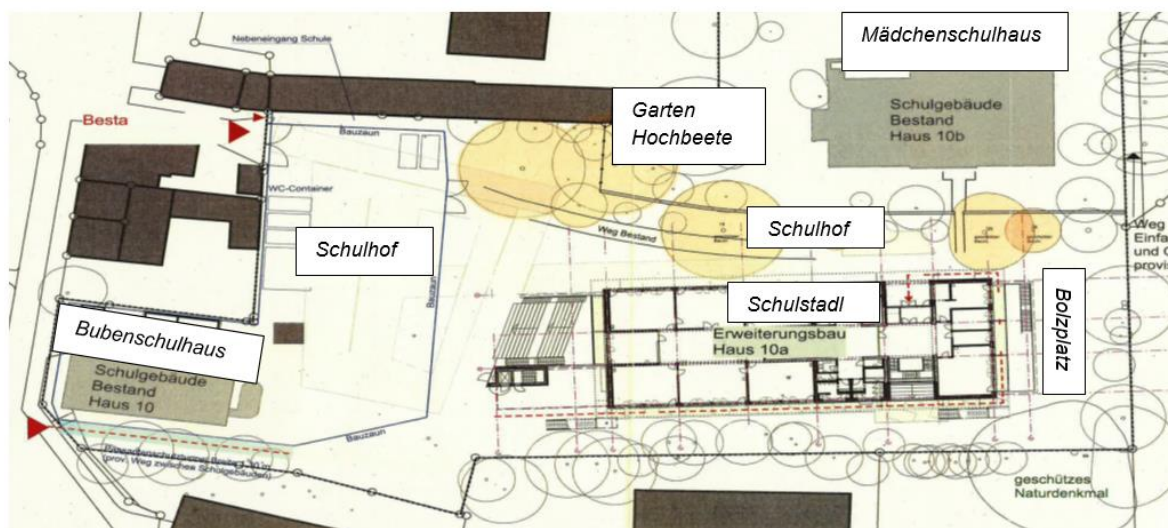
Grundriss Pfanzeltplatz Außengelände
